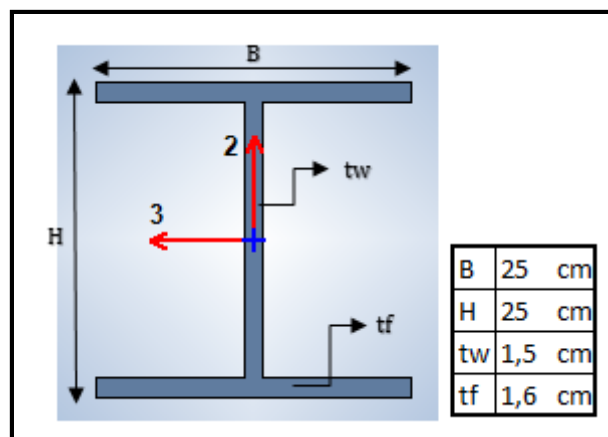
Dimensiones, Columna 4 con pórticos arriostrados diseñados con la NEC.
